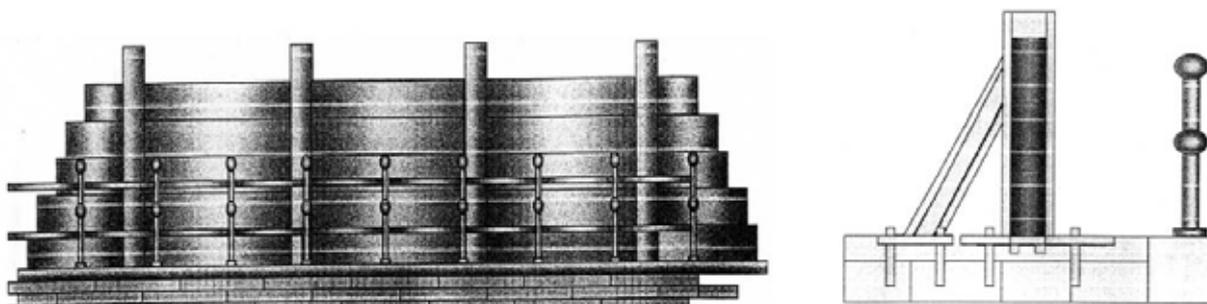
Batardeau à poutrelle avec appuis intermédiaires
